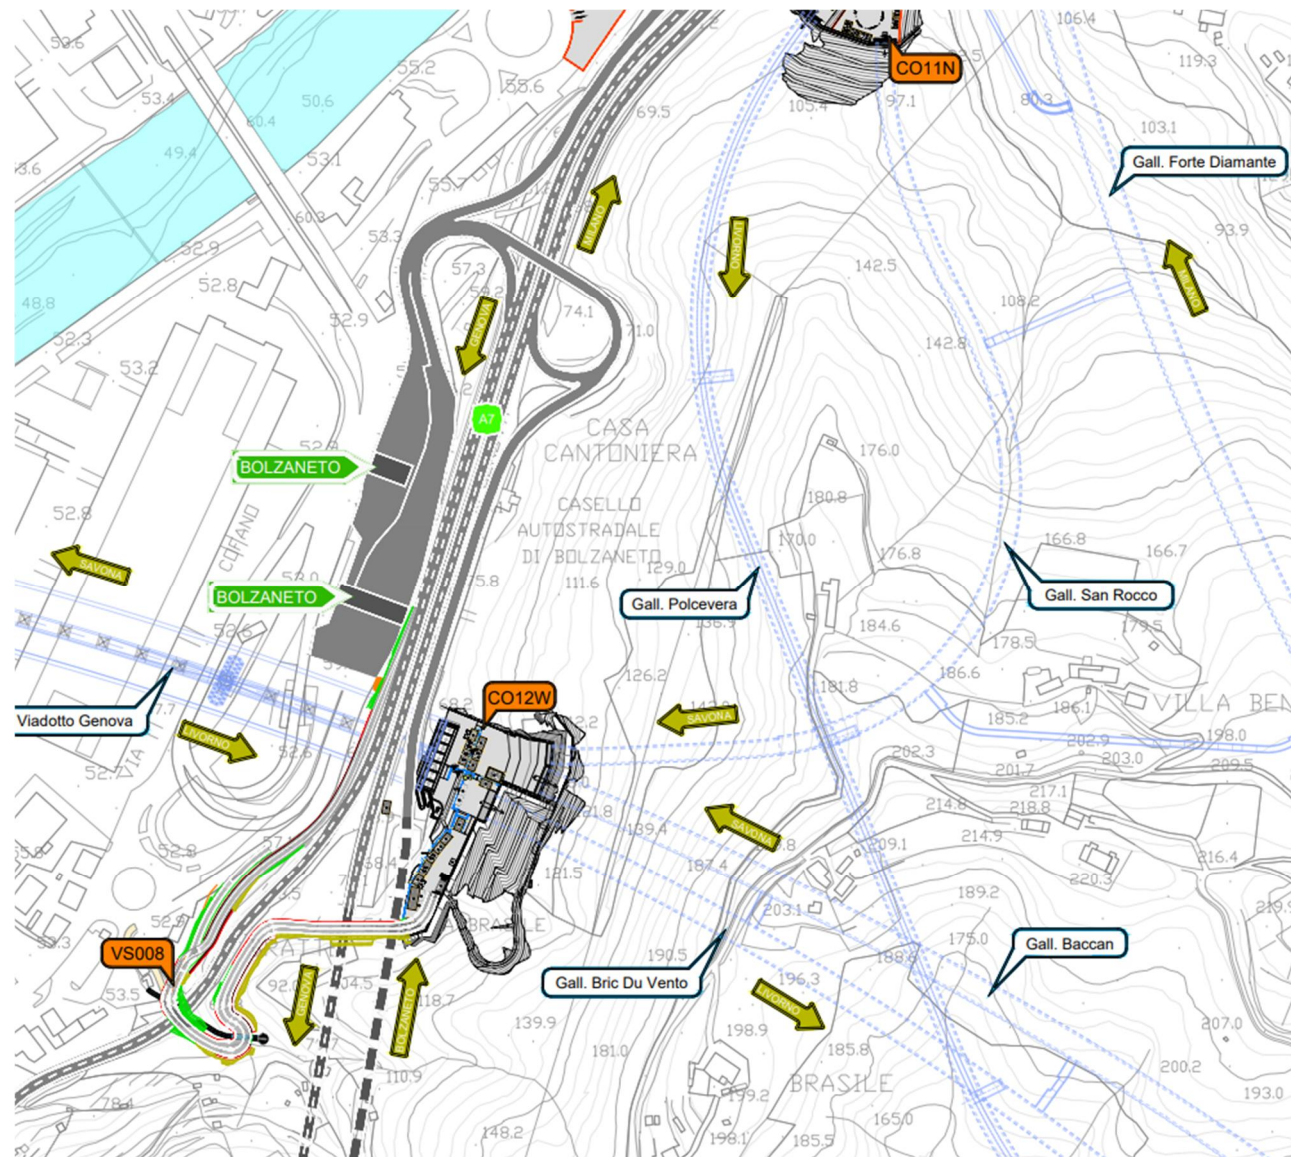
Localizzazione aree di cantiere – Interconnessione Gronda di Ponente (sud)
